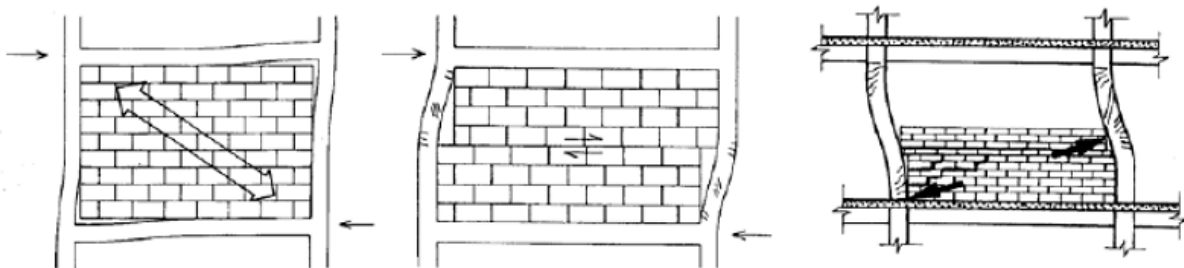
Contreventement par remplissage en maçonnerie [7].
